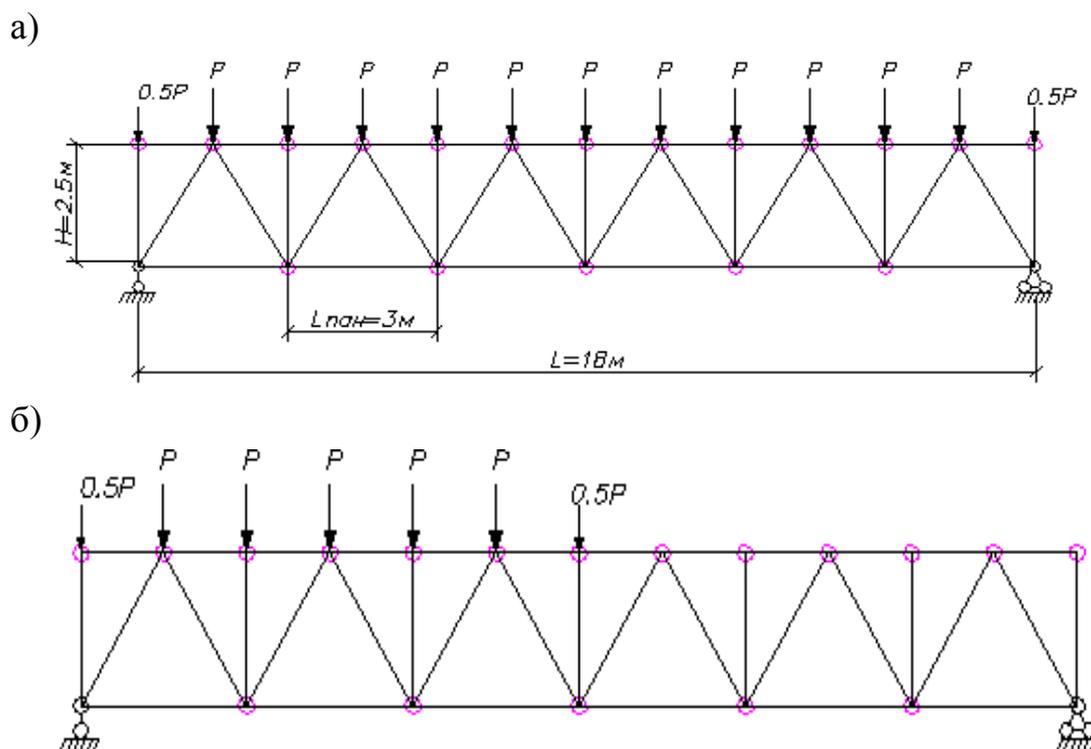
Схема фермы: а – первый вариант загрузки; б – второй вариант загрузки
